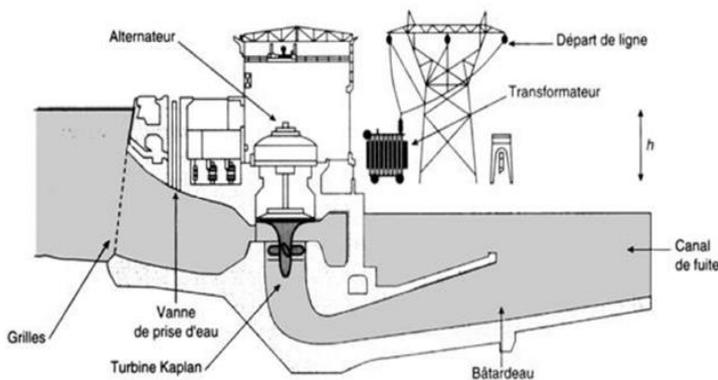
Disposition d'une centrale de basse chute (au fil d'eau). [3]
